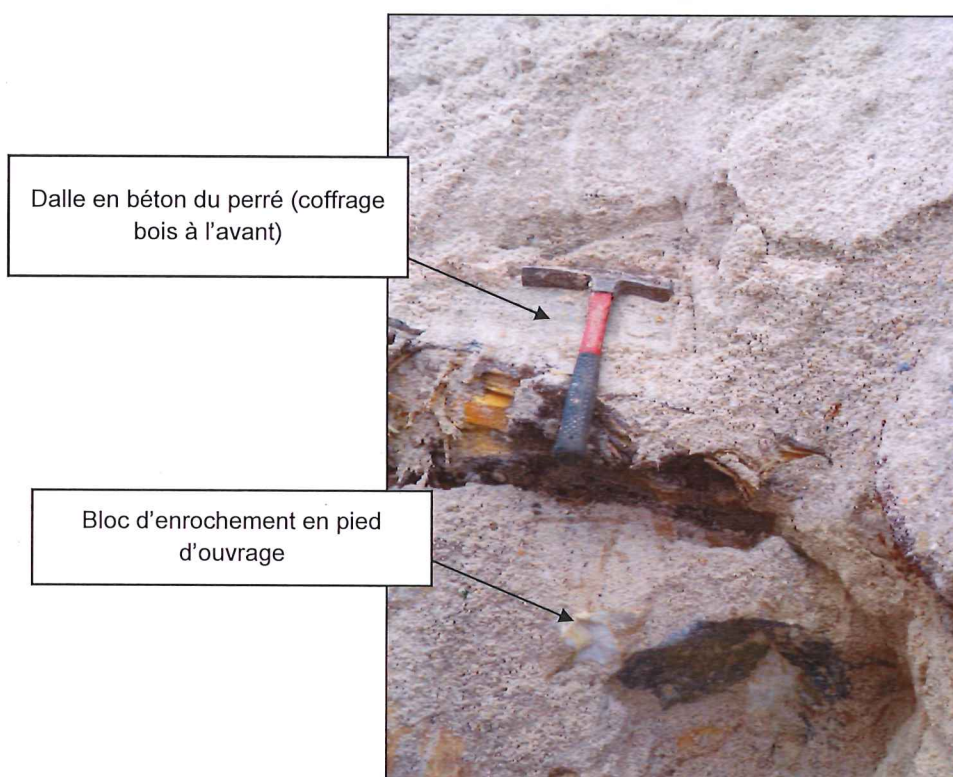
Pied d'ouvrage observé au droit du sondage P1 (Source : Arcadis)
